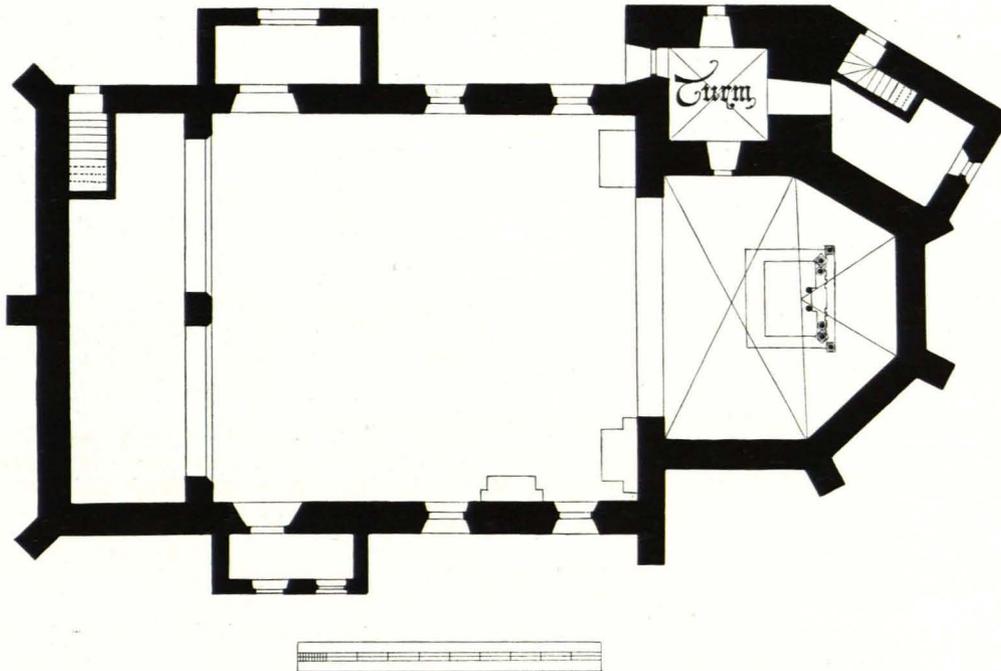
Ottenschlag, Pfarrkirche, Grundriß 1:250 (S. 134)
